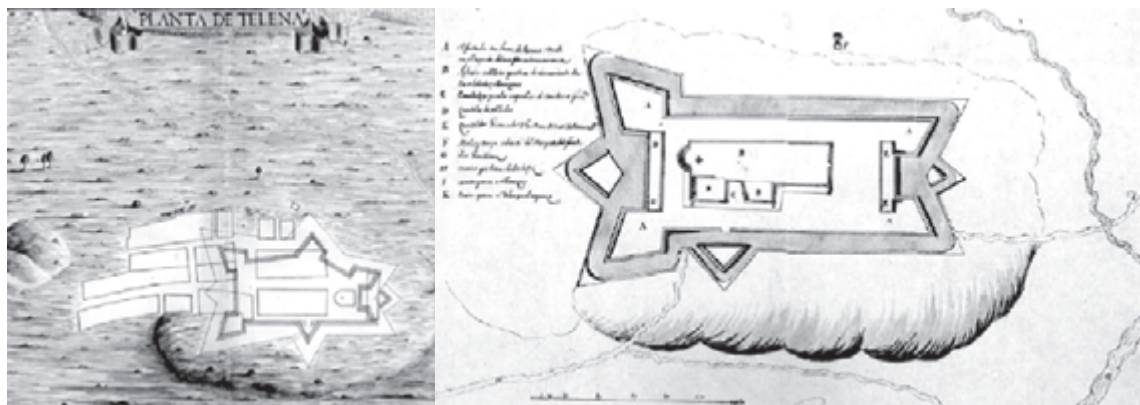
Planos de Telena. A: Plano de Leonardo Ferrari (TESTÓN NÚÑEZ, I.; SÁNCHEZ RUBIO, C. y SANCHEZ RUBIO, R. *Planos, guerra y frontera...*, p. 86). B: Plano del fuerte levantado por el marqués de Leganés (CRUZ VILLALÓN, M. *Badajoz. Ciudad amurallada*, Badajoz, Junta de Extremadura, 1999, p. 41).
